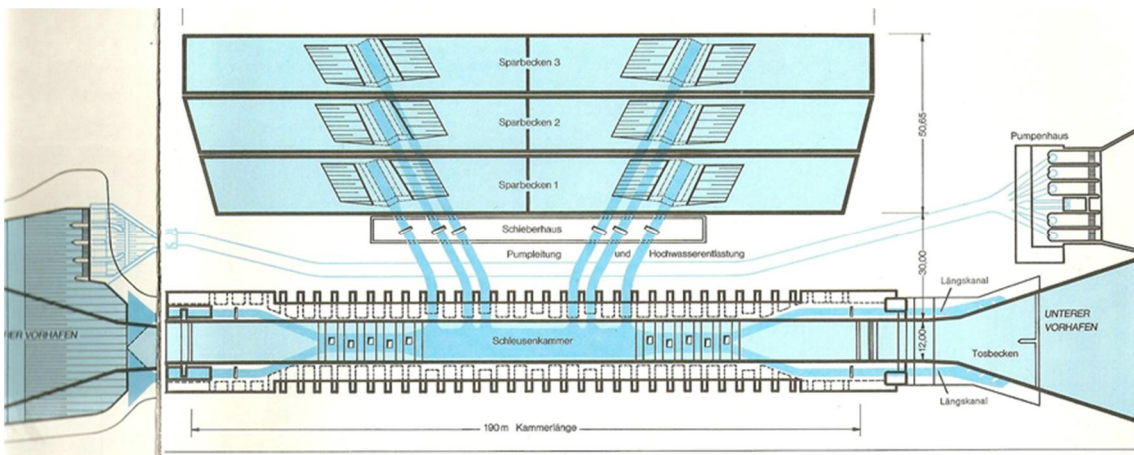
Grundriss der Schleusenanlage mit dem Leitungssystem
